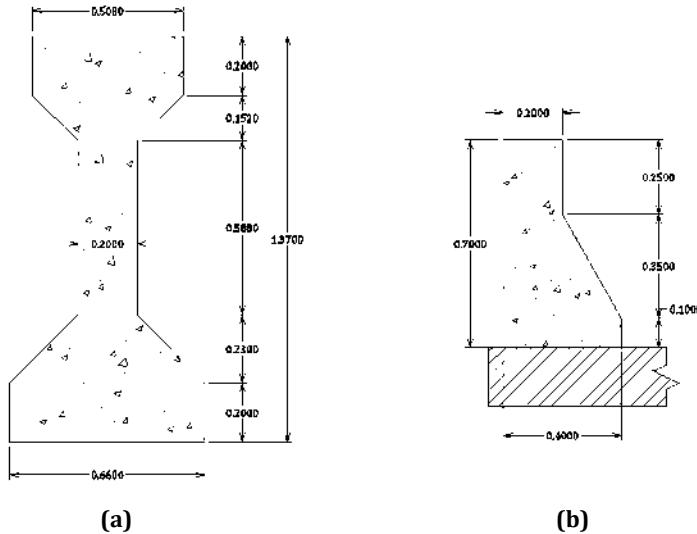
Geometría de: (a) trabe AASTHO tipo IV, y (b) parapeto (acotación en metros)
